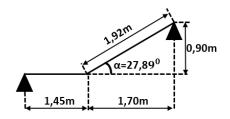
schéma escalier type 02 Figure II.11: schéma statique des volées 1 et 3
